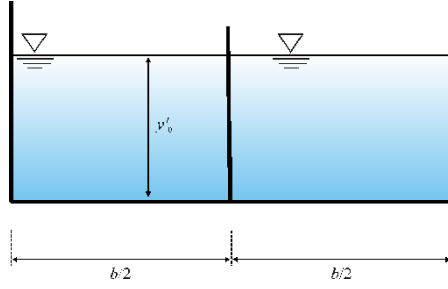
Sezione del canale a seguito dell'inserimento del setto di separazione
